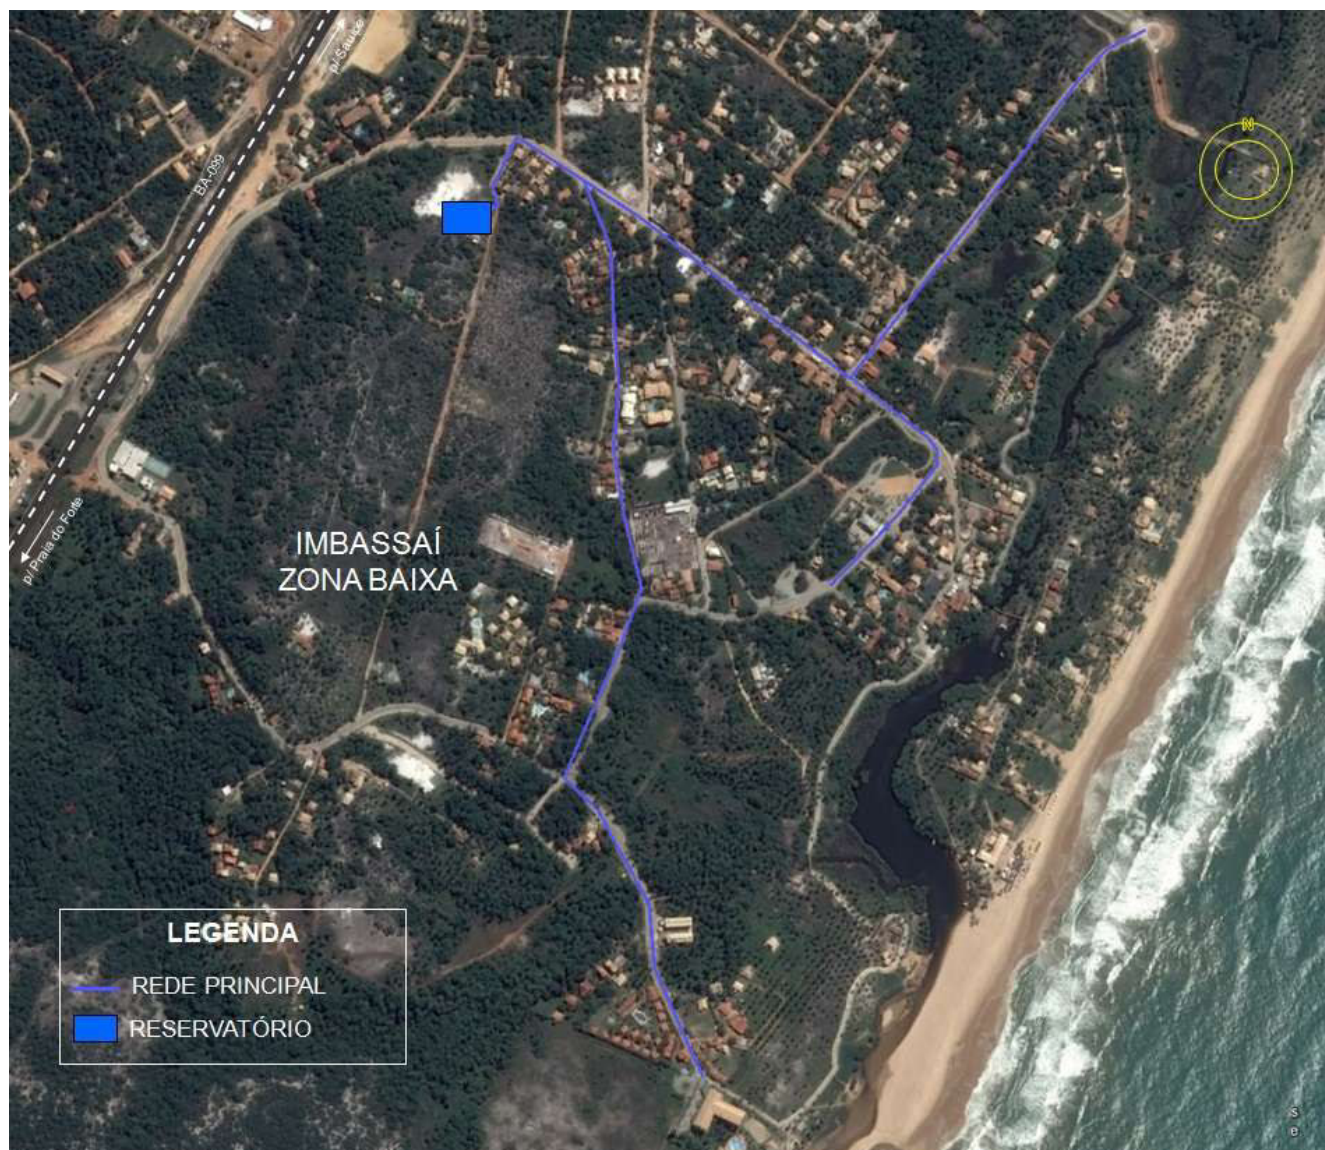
Esquema geral da rede principal de Imbassai – Zona Baixa
